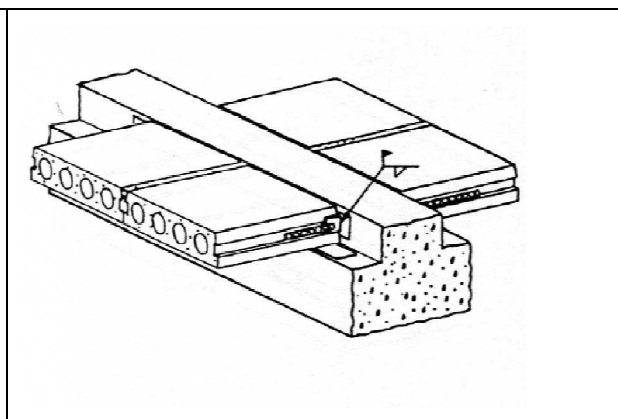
Ligação de lajes através de chapas aparafusadas, assentes em neoprene, em paralelo com a laje (PCI)
